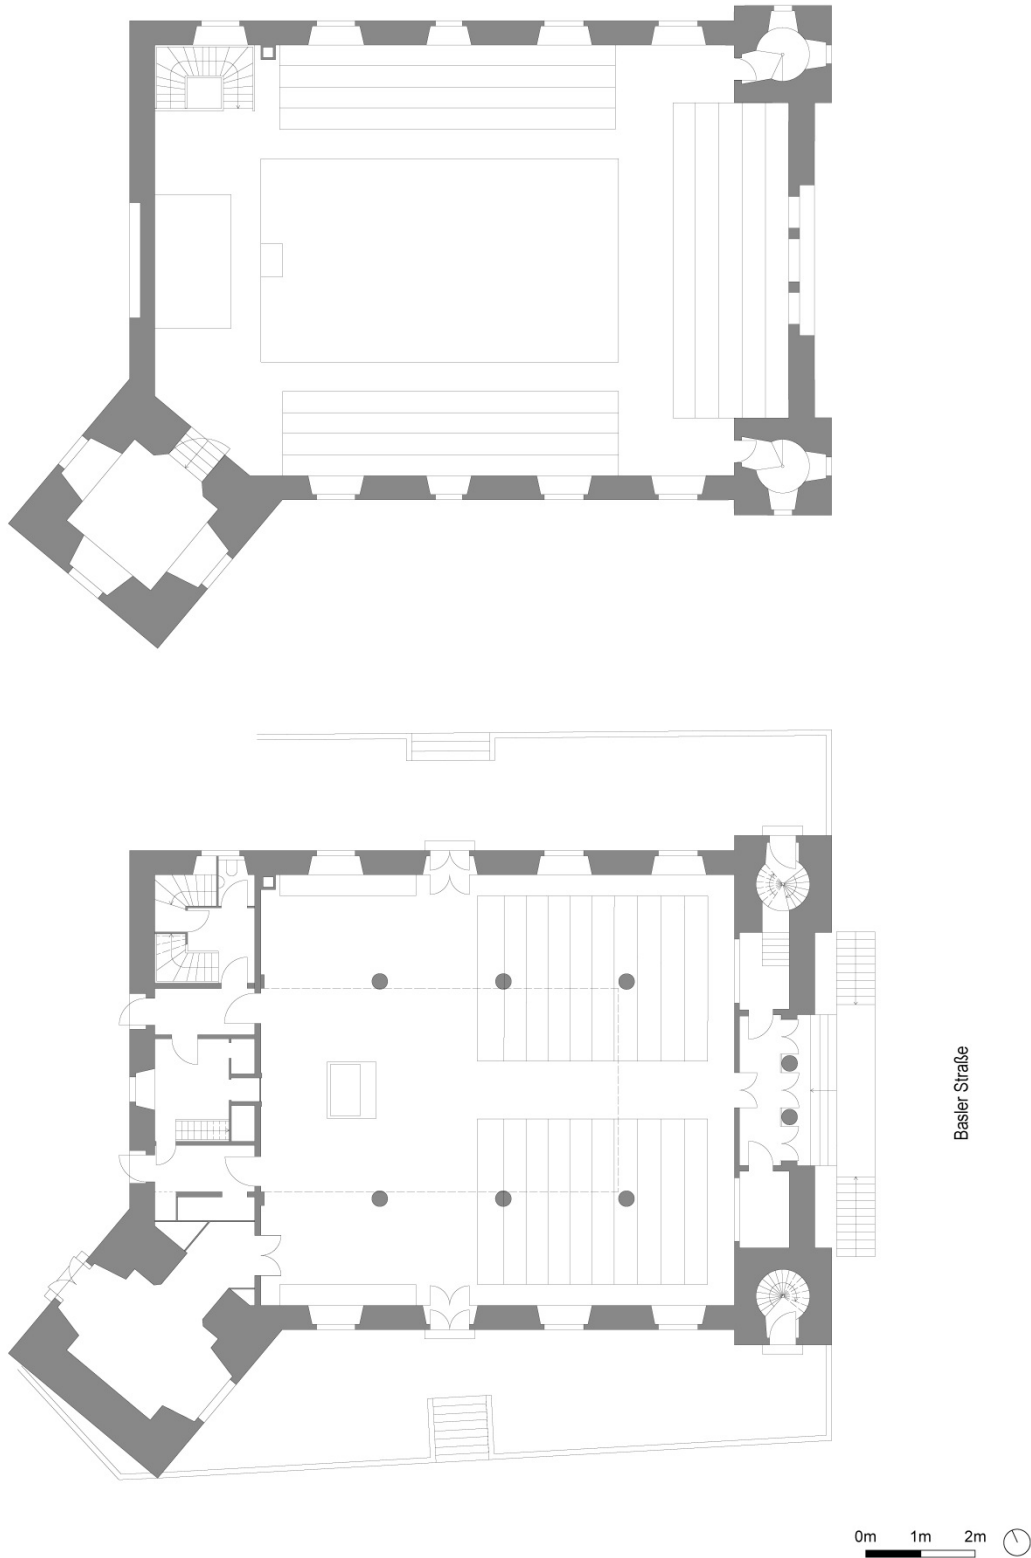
Grundrisse EG (unten) und Empore (oben) (Zeichnung pro ki ba auf Grundlage historische Planunterlagen)
